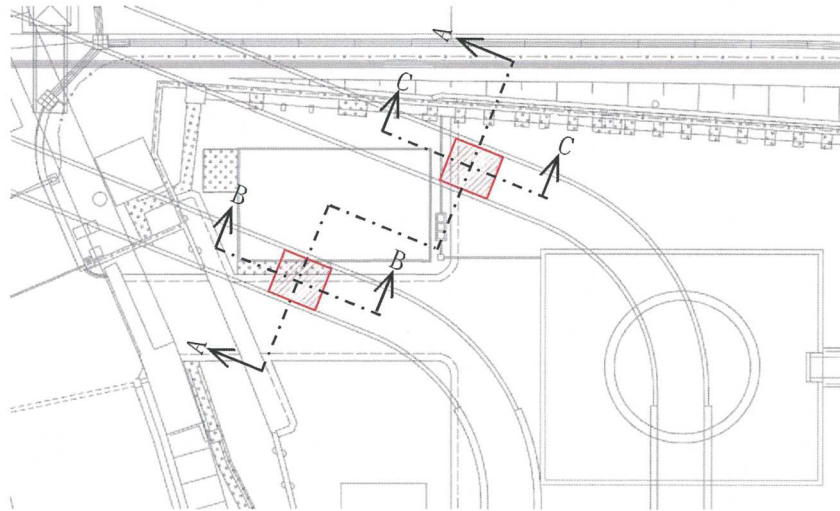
(1) 取放水路流路縮小工（第1号機取水路）(No. 1), (No. 2) 平面図
